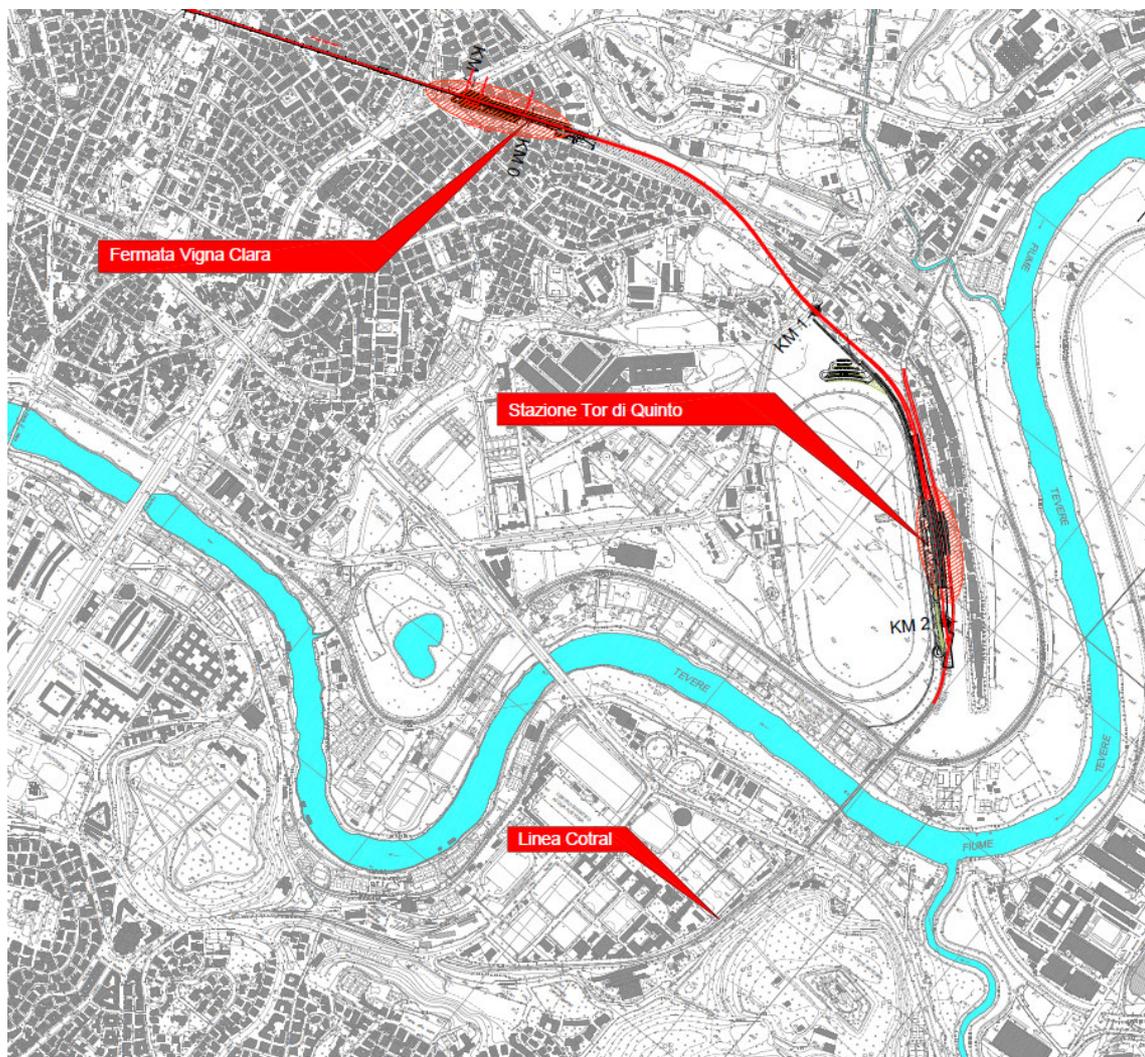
Stralcio planimetrico Tratta Vigna Clara – Stazione di Tor di Quinto
